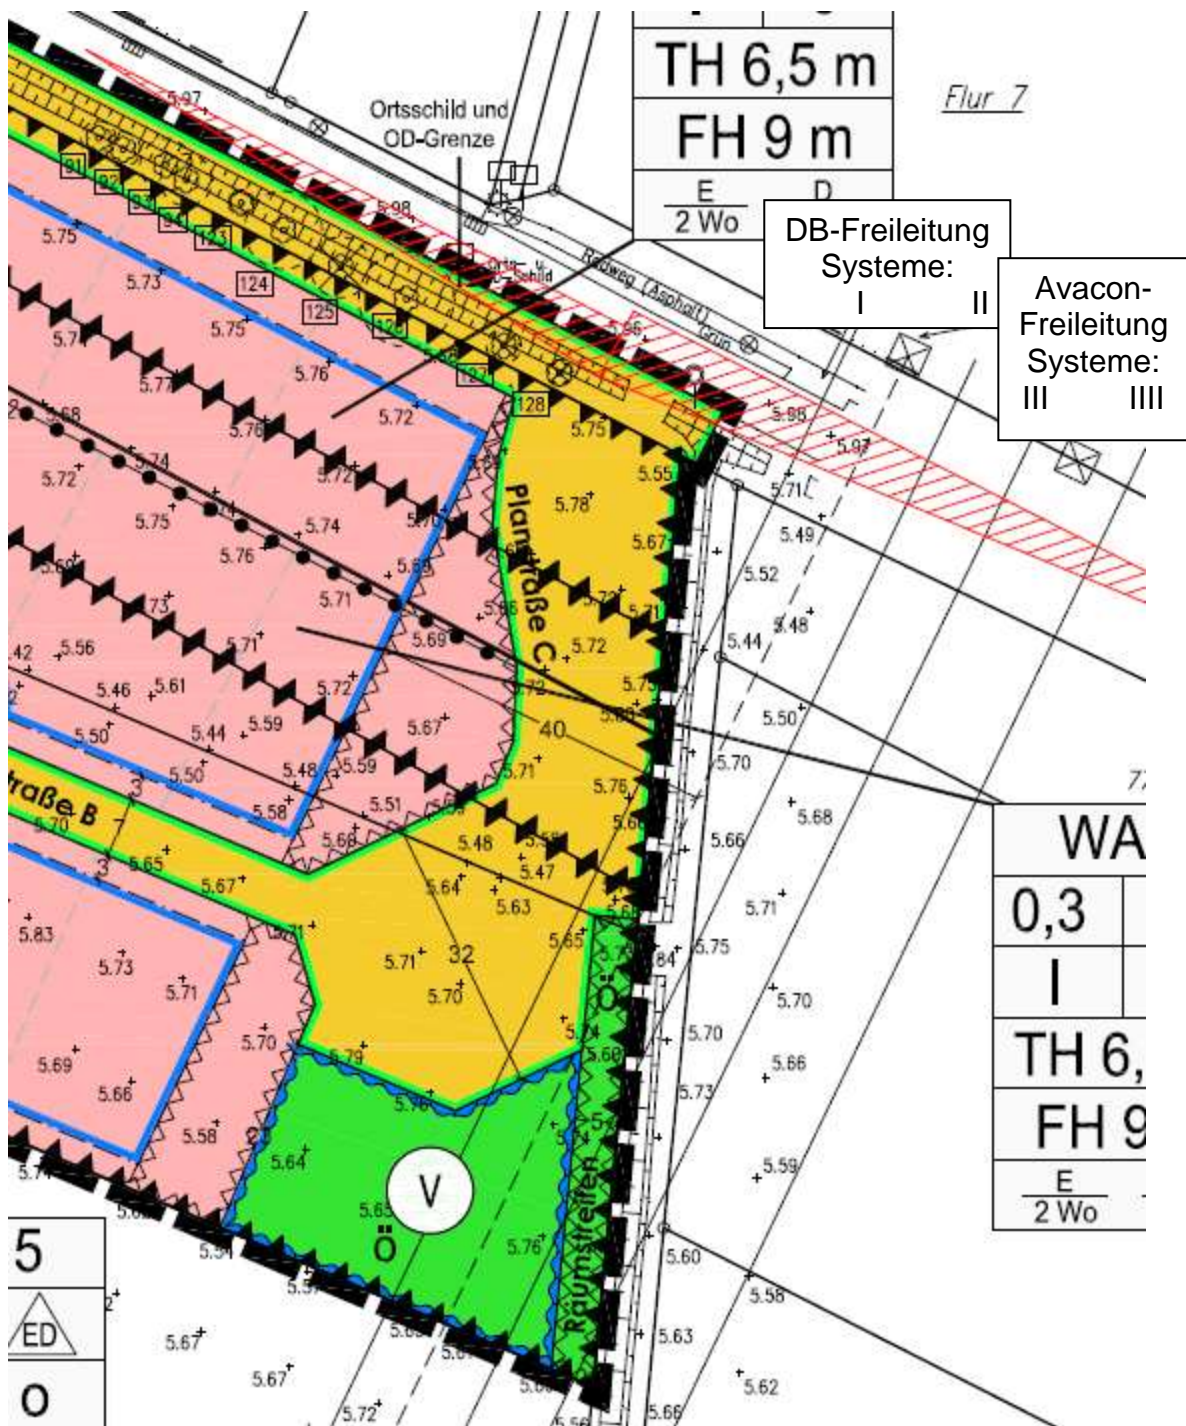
Ausschnitt aus: B-Plan „Ritzkamper Weg“, Gemeinde Brietlingen Flur 8
